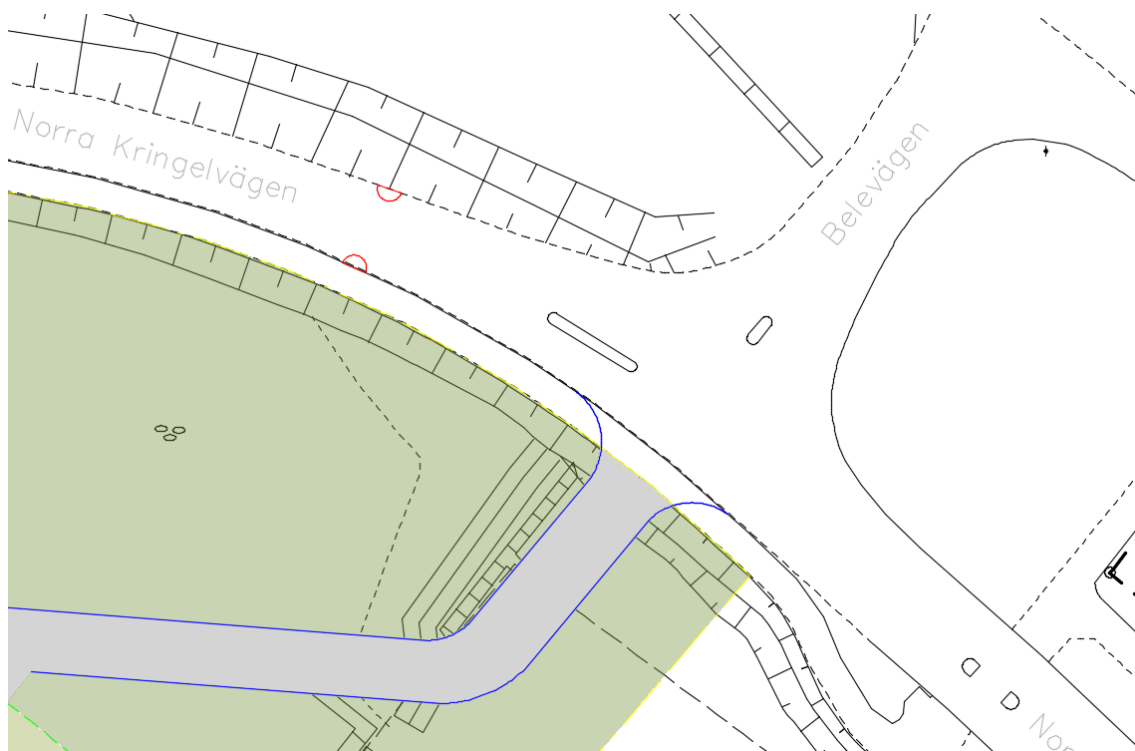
Planerad byggnads- och gatustruktur inom planområdet
